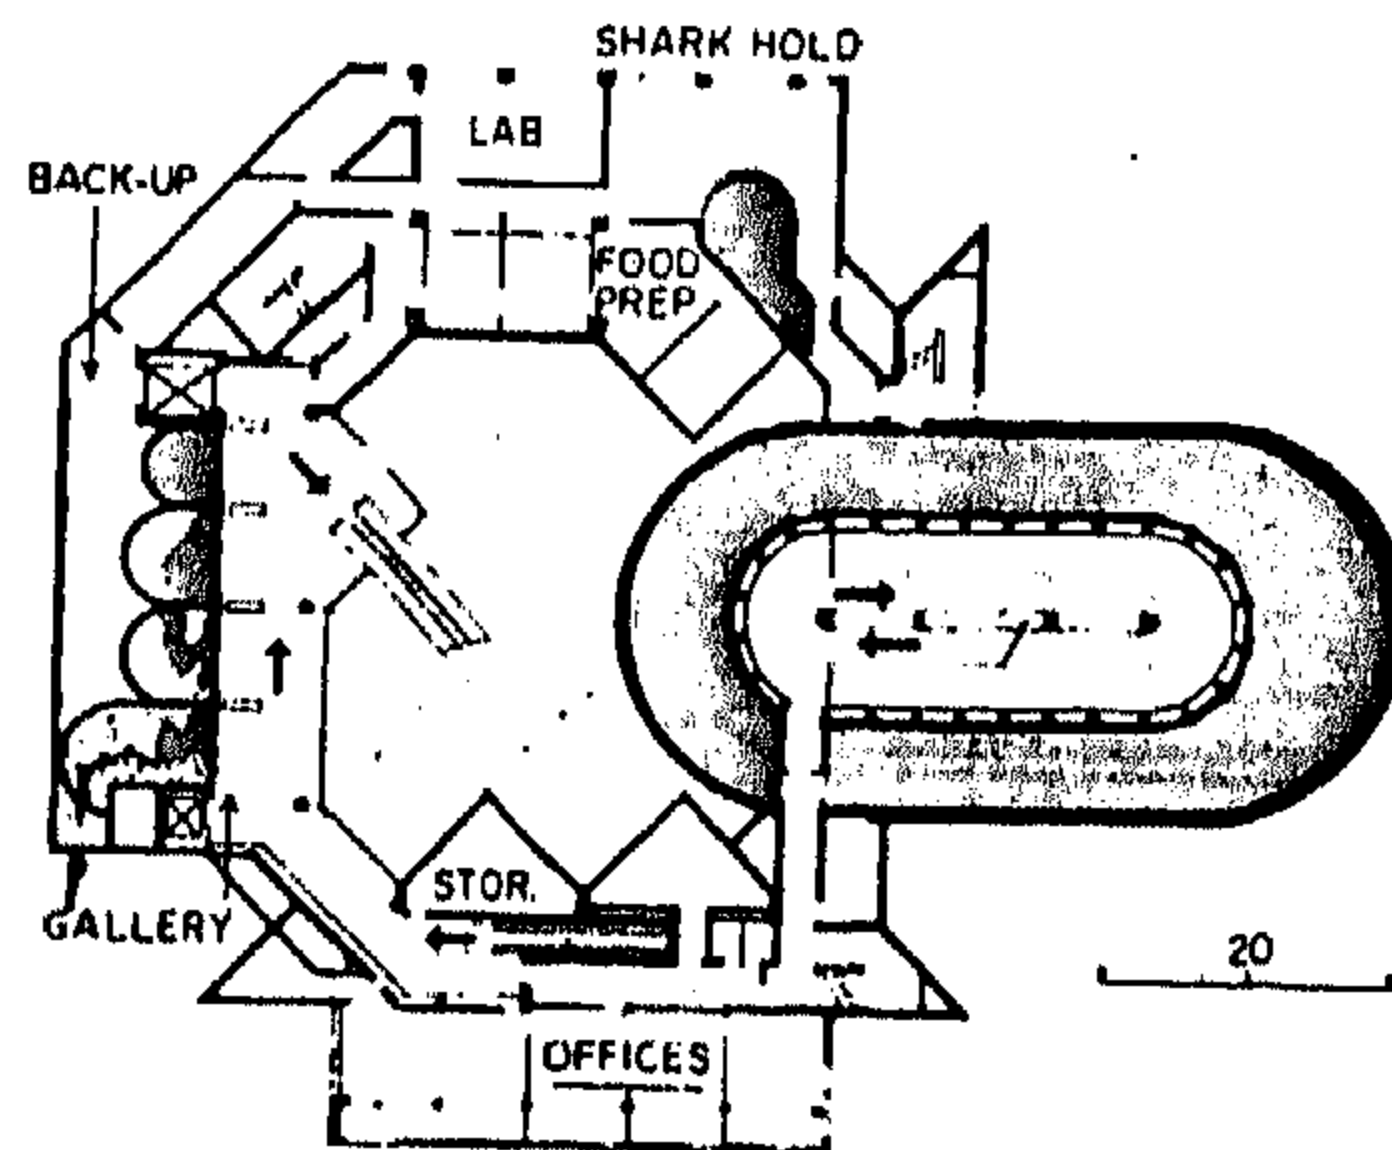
مسقط أفقي الميزرانيين
